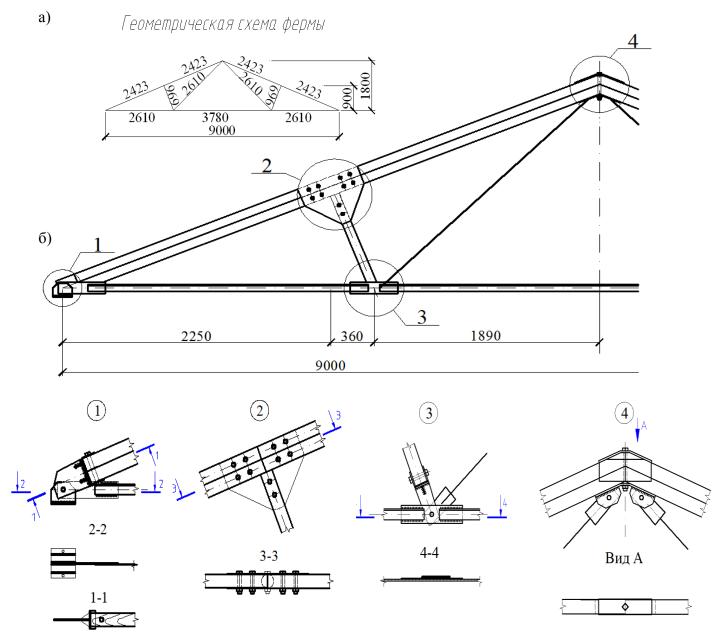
Металло-деревянная ферма пролетом l=9,0 м. а) геометрическая схема фермы; б) общий вид фермы и детали узлов.
